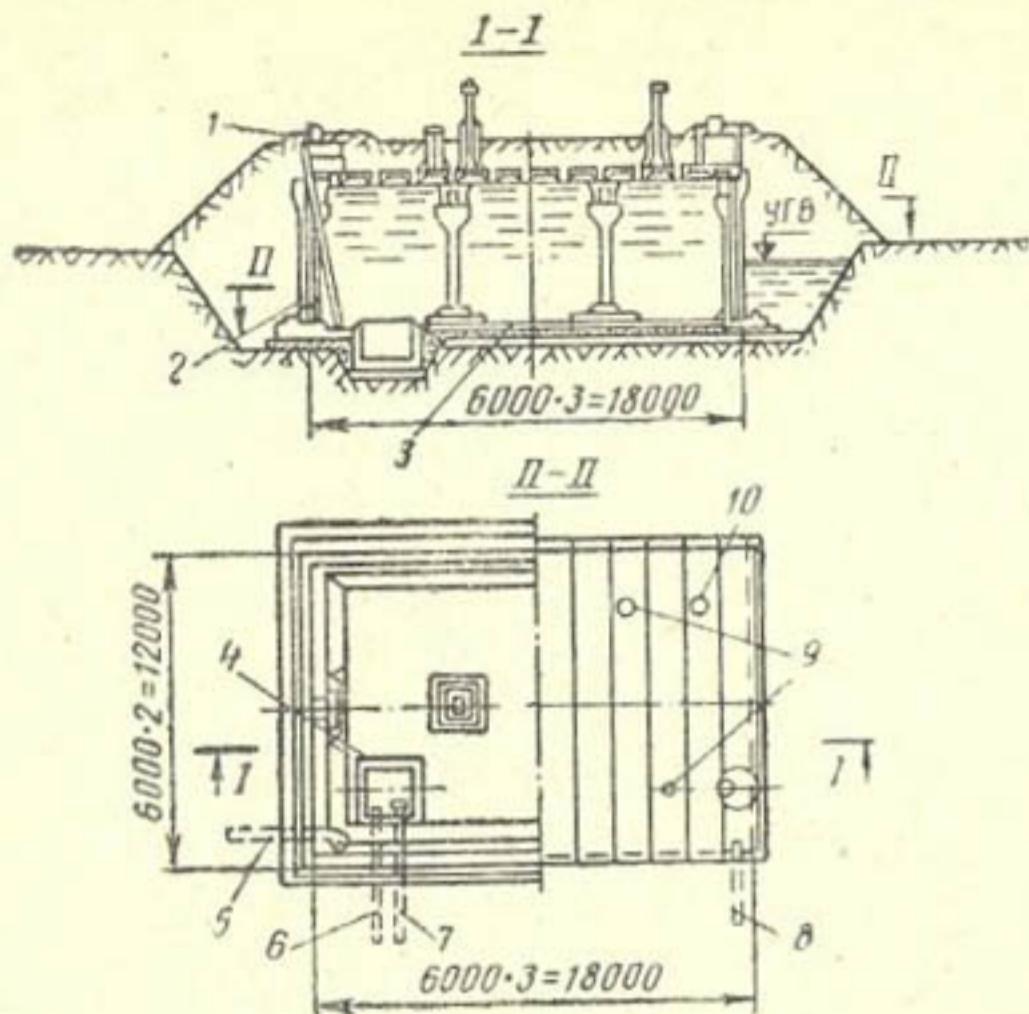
Резервуары для воды железобетонные прямоугольные заглубленные:
